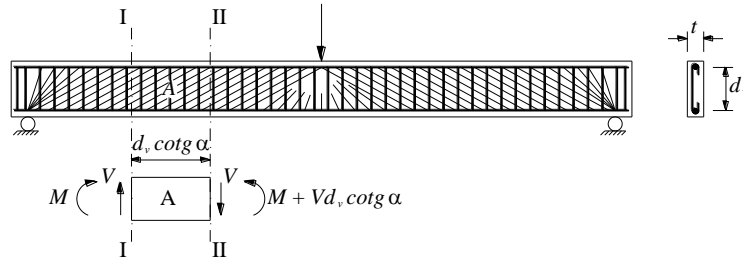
Análise de uma viga de betão armado com base no modelo de treliça plana [23]
